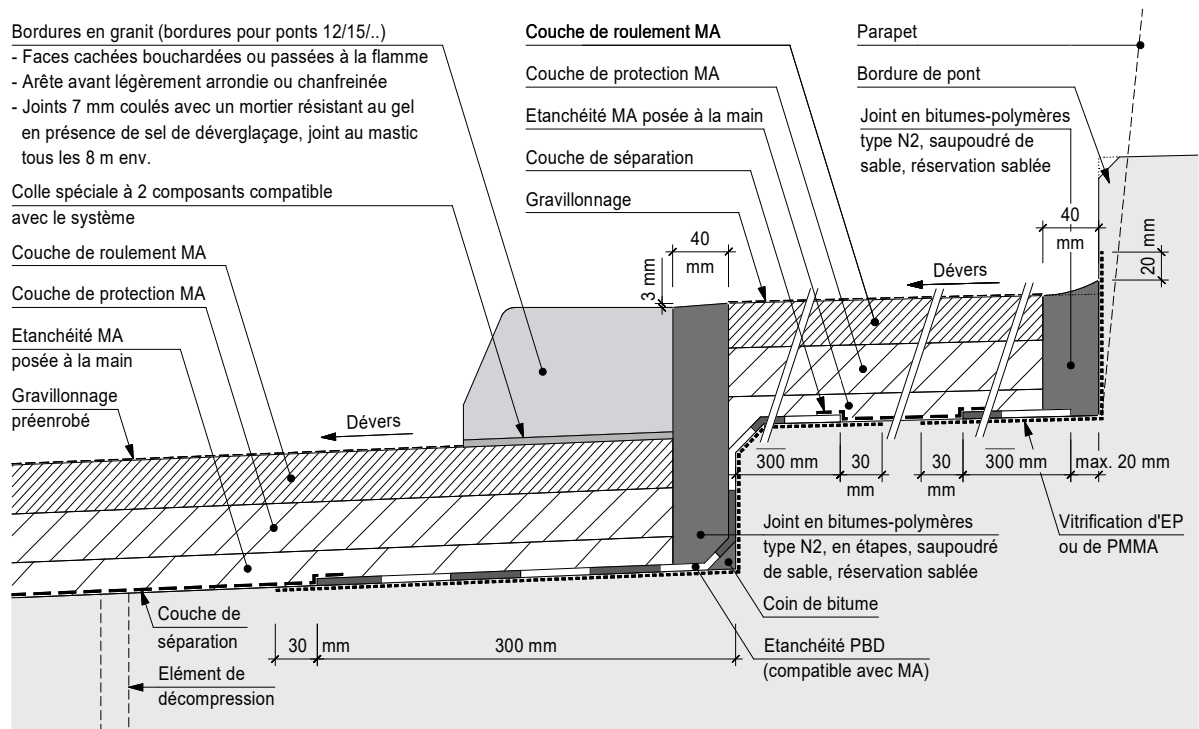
Système d'étanchéité MA - Raccord aux trottoirs - Bordure de trottoir collée - Point haut
